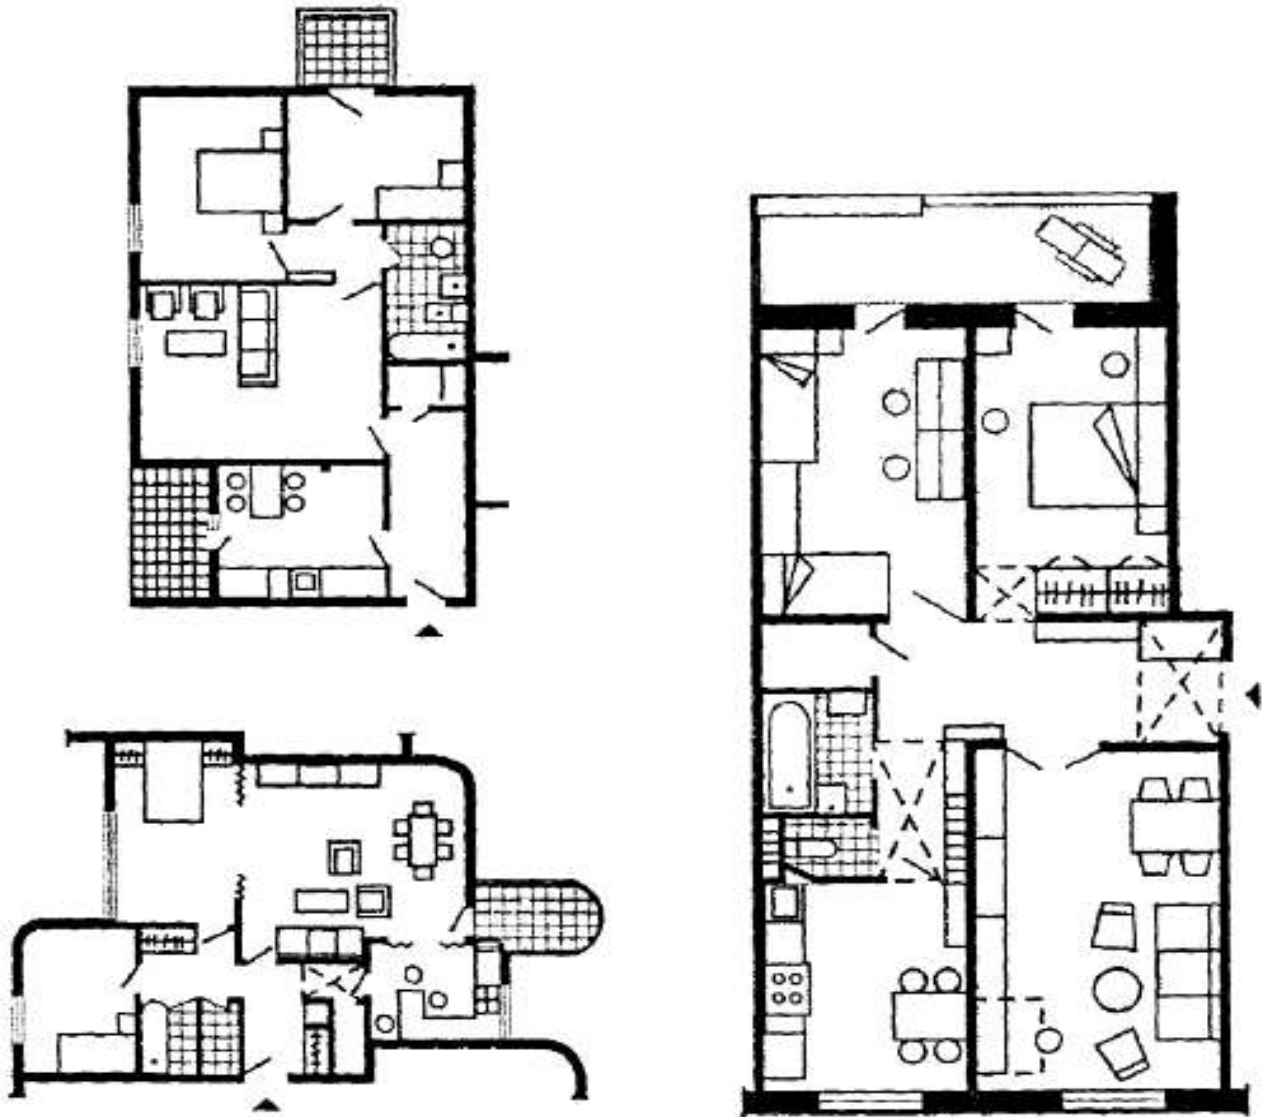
Примеры планировочных решений трехкомнатных квартир
